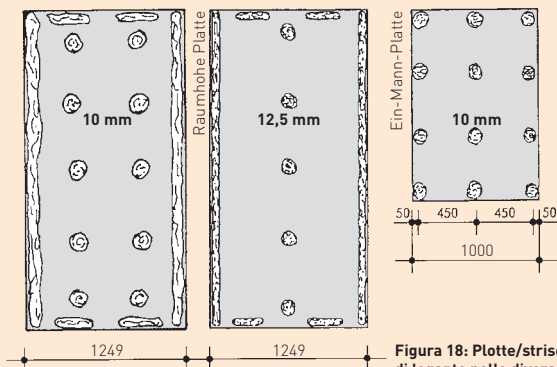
Plotte/strisce di legante nelle diverse disposizioni
